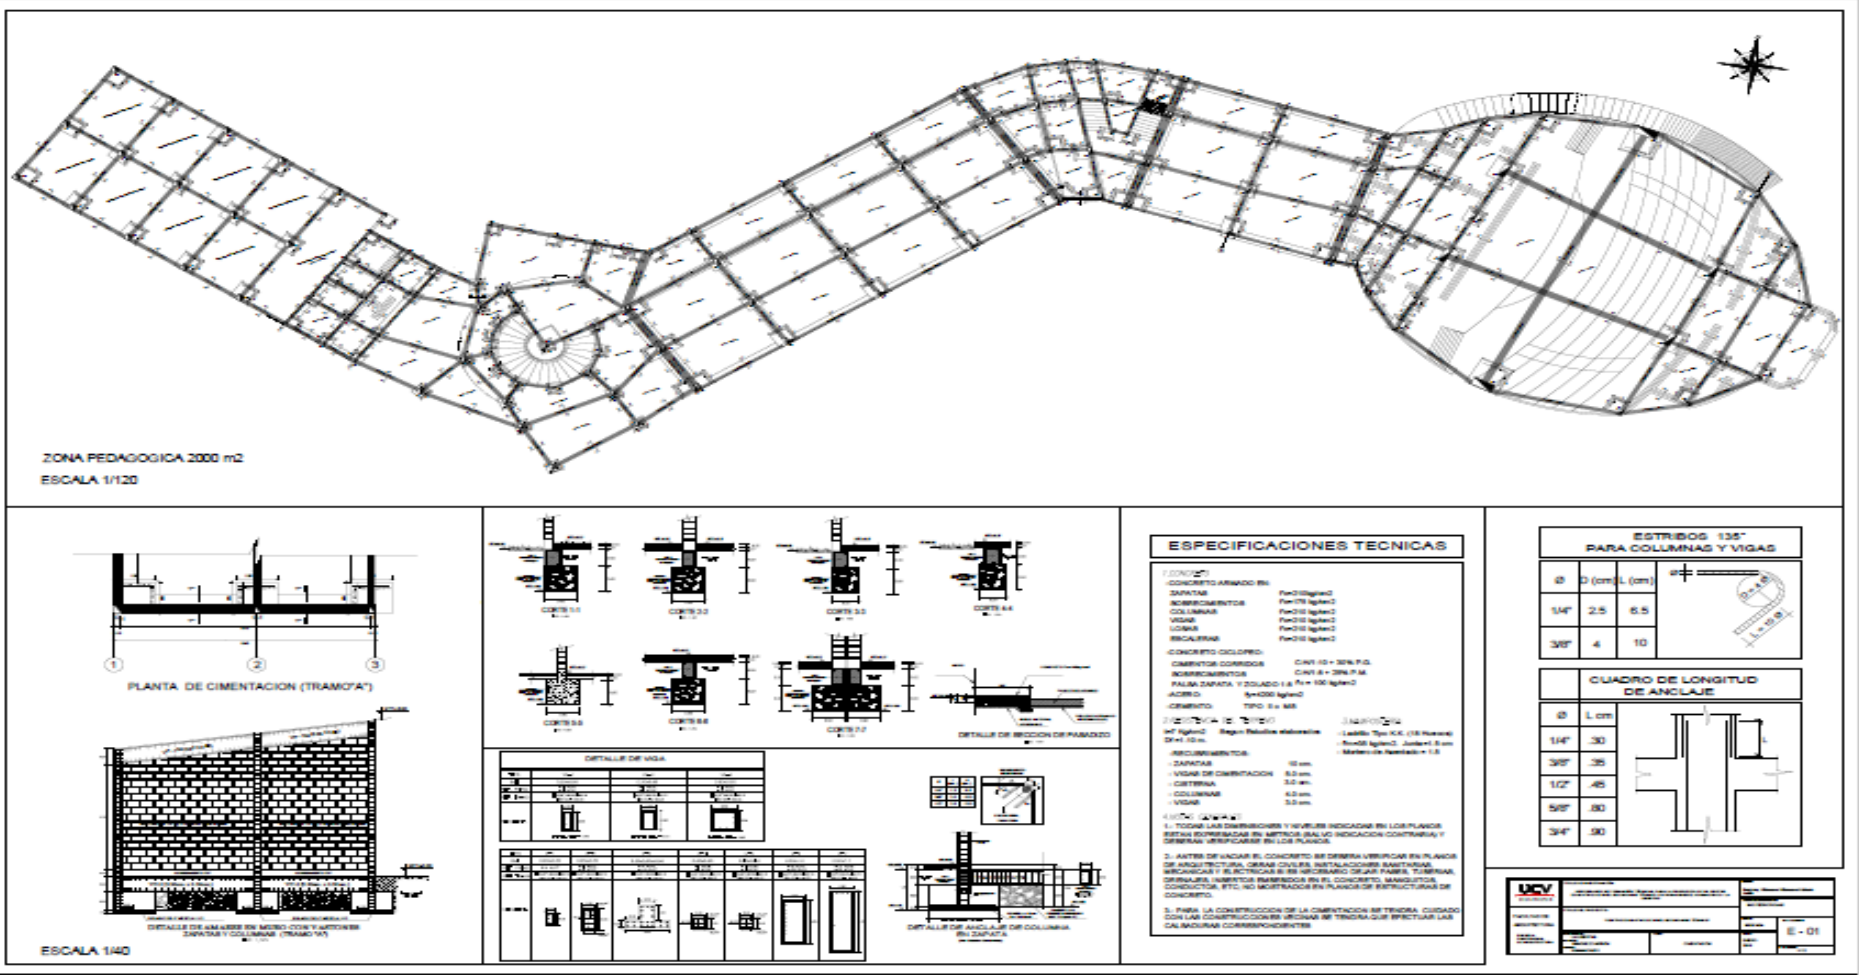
Plano Diseño Estructural General – Cimentación - Plano N° 09 - Lamina E-01
